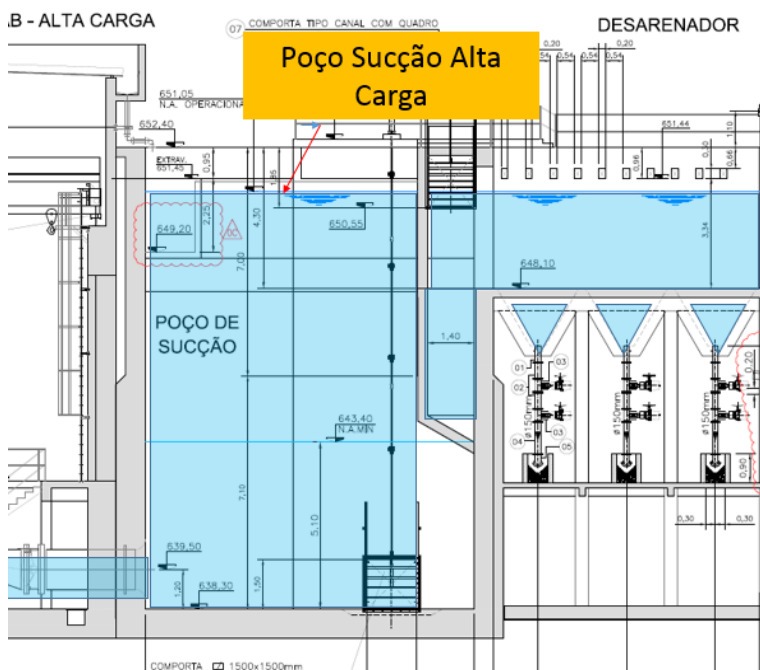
Poço de sucção da Estação Elevatória de Alta Carga, vista em Corte
